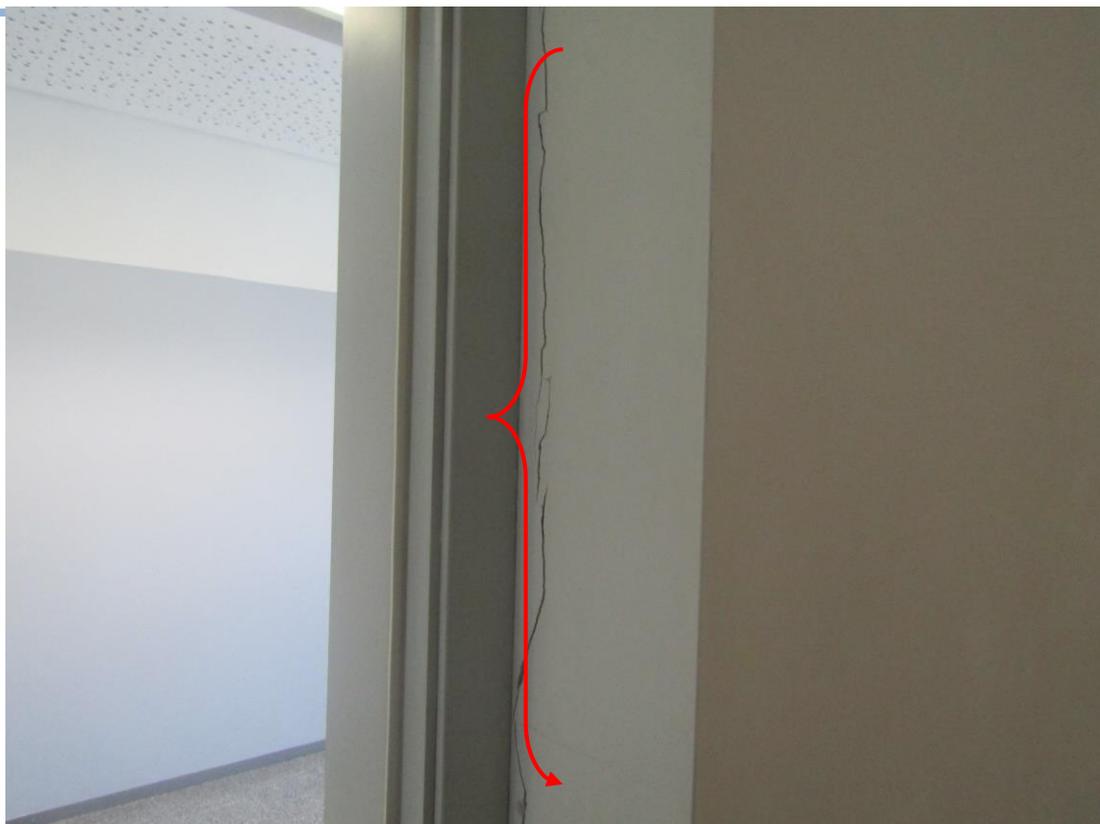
FISSURAÇÃO EM OMBREIRAS (PORTAS SALA DE AULAS)
